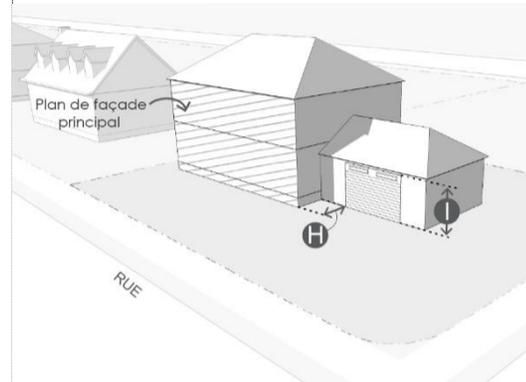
Retrait d'un garage par rapport à un plan de façade principal et hauteur d'une porte de garage
